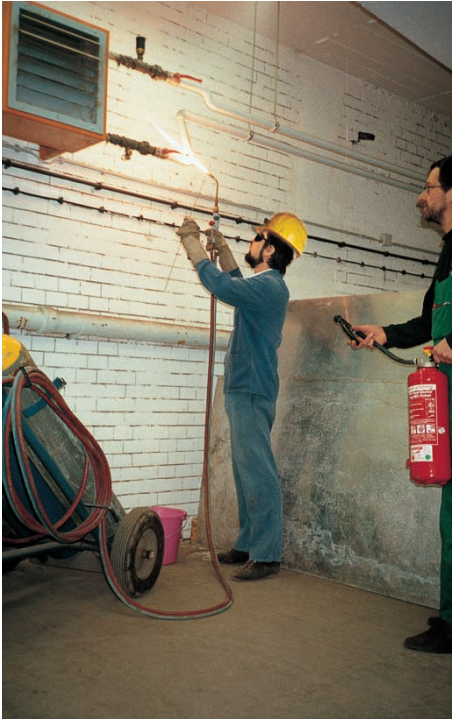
Schweißer mit Schutzbrille und Schutzhandschuhen beim autogenen Schweißen. Ein zweiter Mann steht mit Löschgeräten als Brandwache einsatzbereit. Brennbare Gegenstände, die nicht aus dem Umkreis der Schweißstelle entfernt werden konnten, sind durch Blechtafeln gegen Flammen, Funken und glühende Metallteilchen geschützt.
